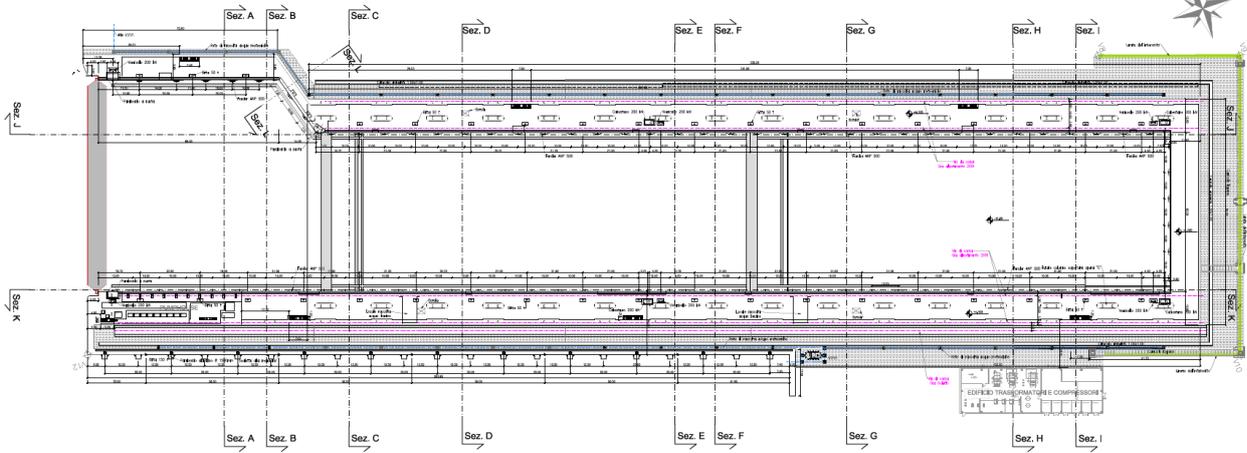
Planimetria e sezioni del nuovo bacino di carenaggio
